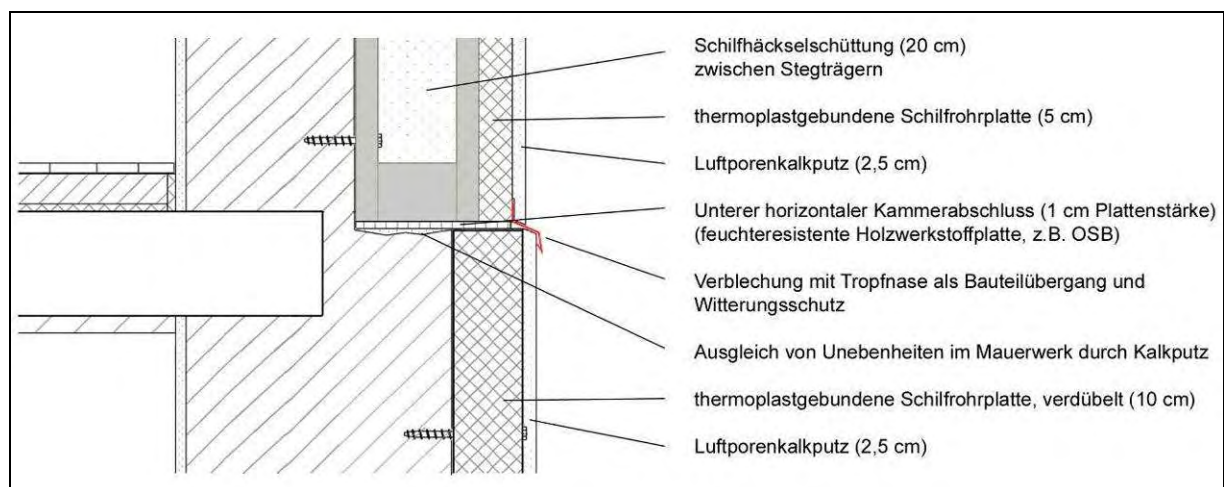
Anschlussdetail Geschoßsprung von 50 zu 30 cm Mauerstärke
